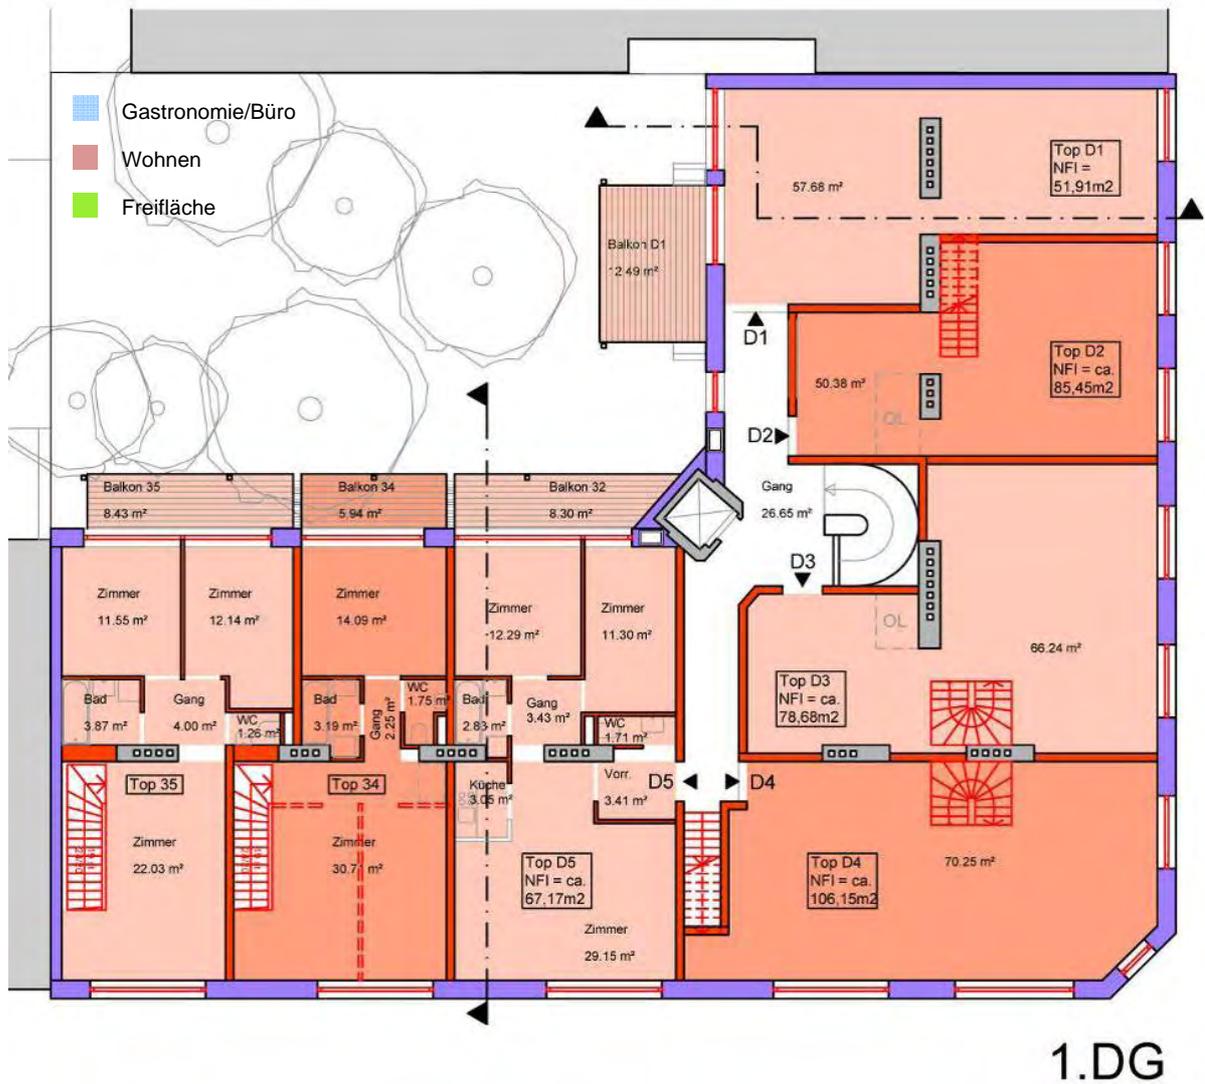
Grundriss 1. Dachgeschoß
